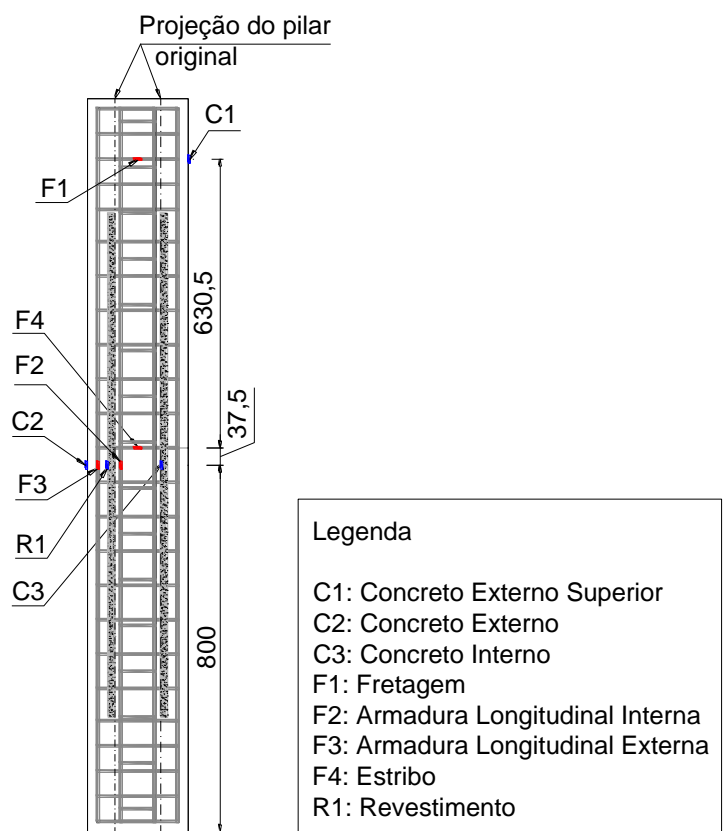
Posicionamento dos extensômetros do pilar PR_{75}
